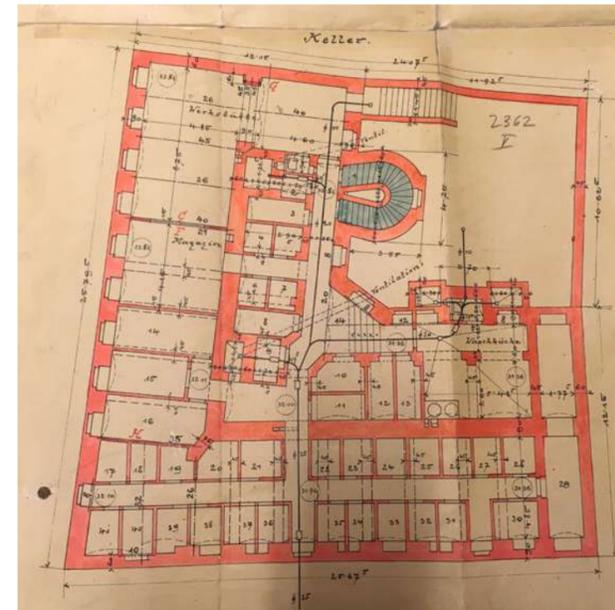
Keller Grundriss des Eckgebäudes Reinprechtsdorfer Straße / Storkgasse (links, oben)
